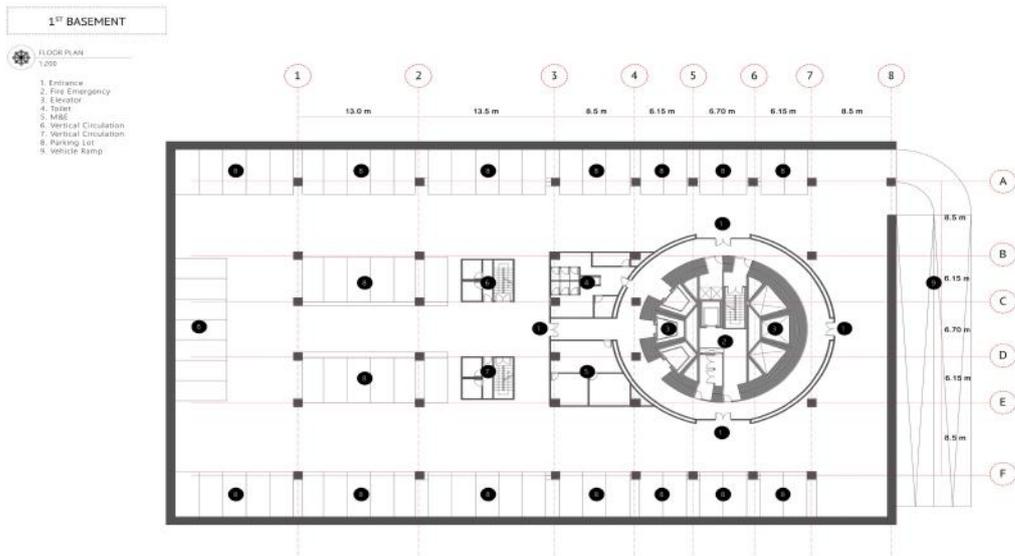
Denah Lantai 1. Sumber: Dok.Prbadi
